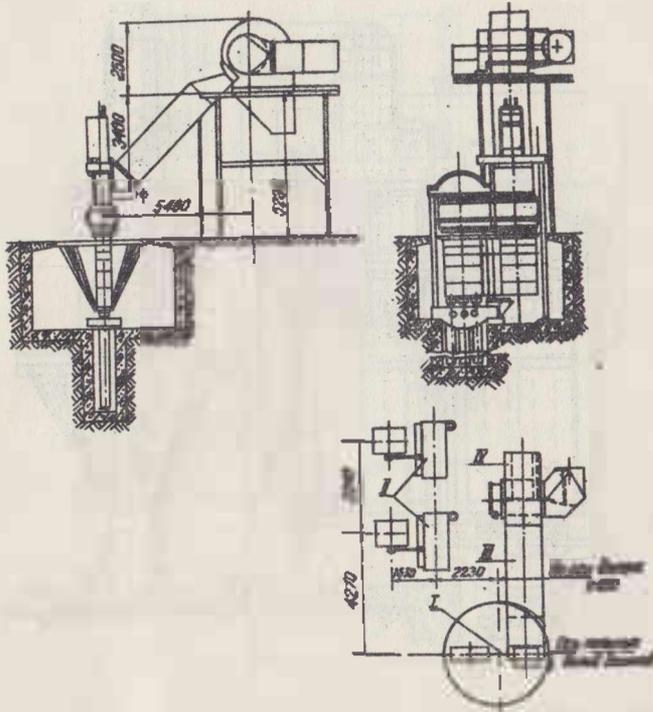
Схема расположения прессовой установки фирмы "Ливитт-Джамус"
